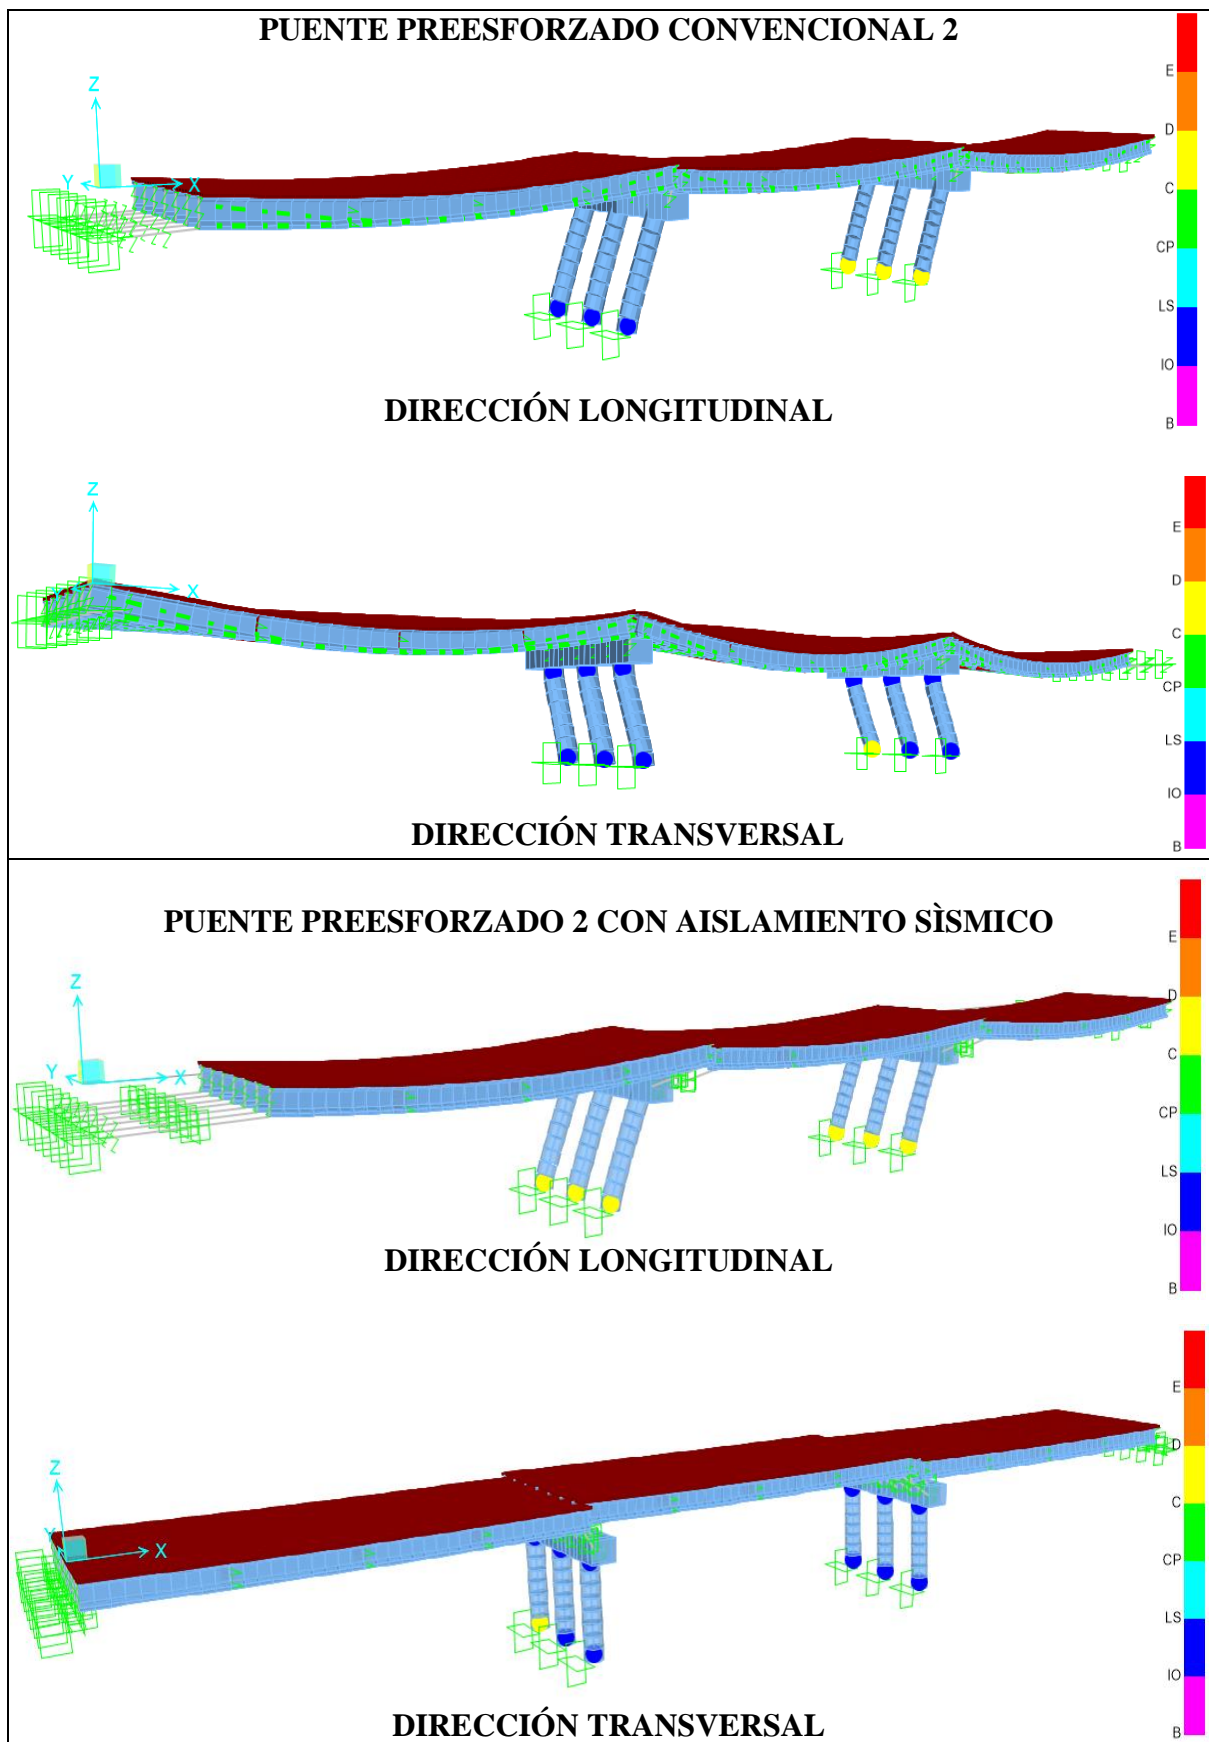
Rótulas plásticas de los pilares del puente preesforzado 2 con y sin aislamiento sísmico en el punto de máxima capacidad.
